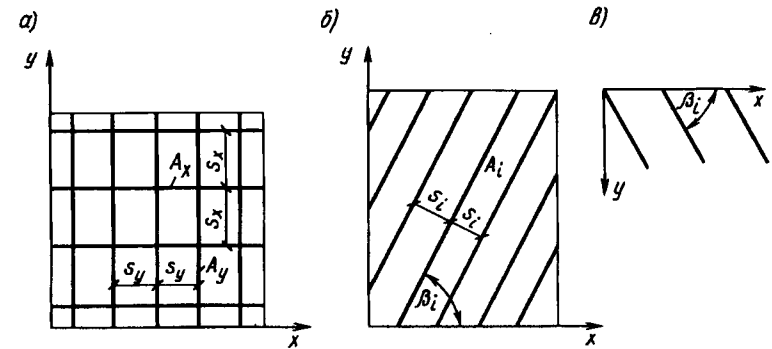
Схемы армирования плоских конструкций a — ортотропное; b, β — косоугольное
